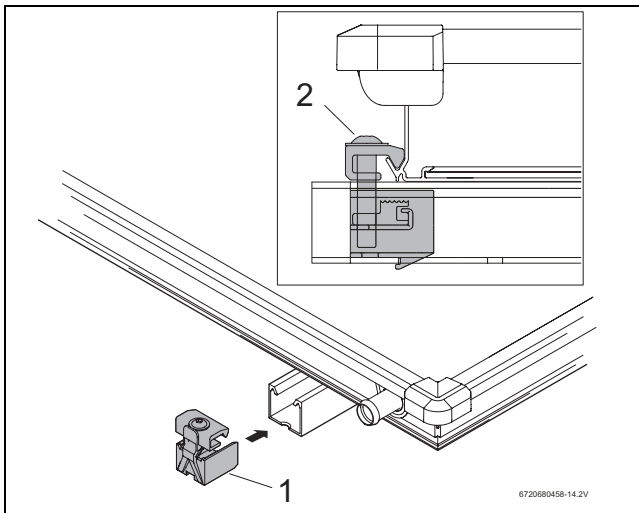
Односторонній натяжний пристрій для колектора ліворуч
